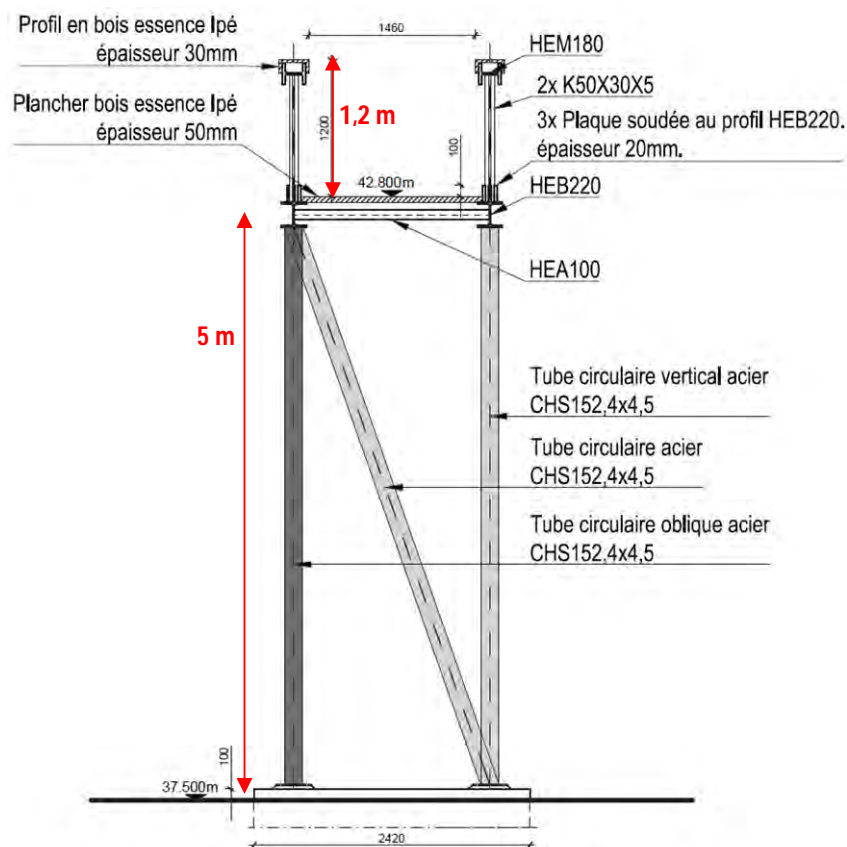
Coupe transversale de la passerelle piétonne (BMM, 2017)
